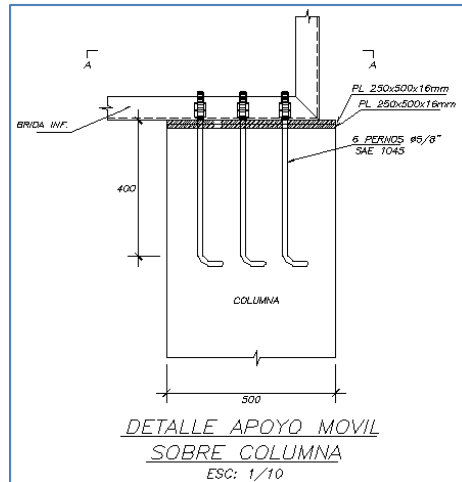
DETALLE DE APOYO SOBRE COLUMNA
